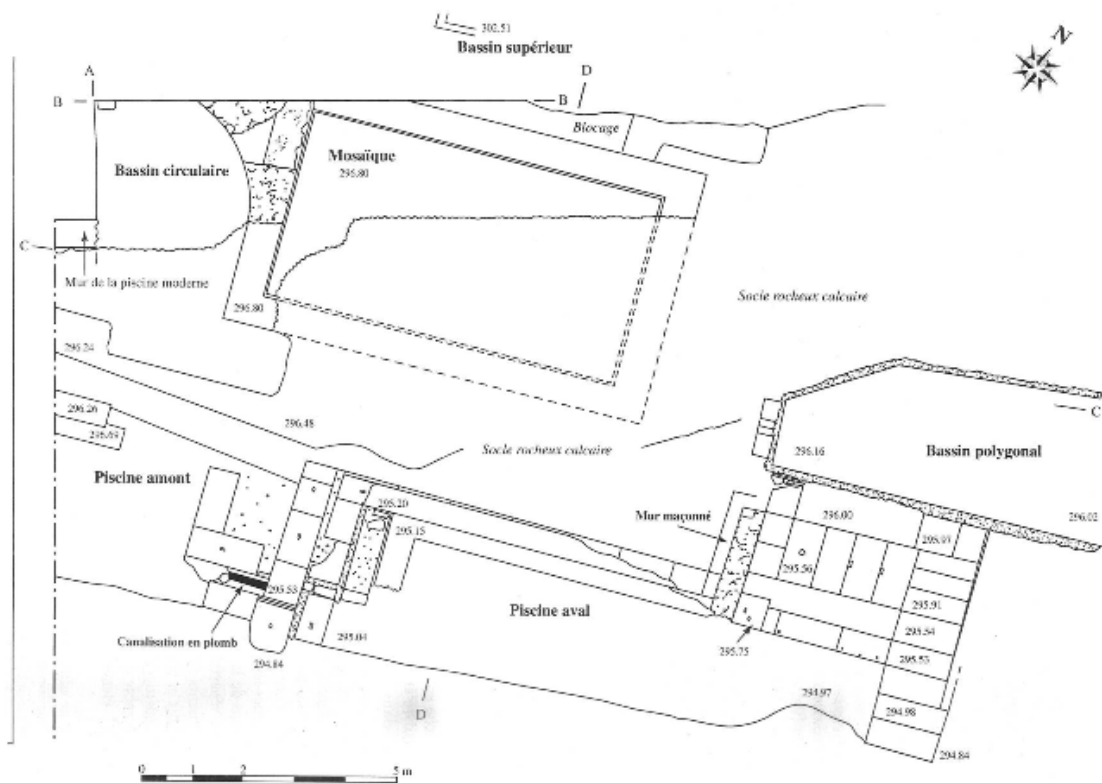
Planimetria dell'impianto termale di Rennes-les-Bains (da ALESSANDRI, RANCOULE 2002, p. 145, fig. 5).
